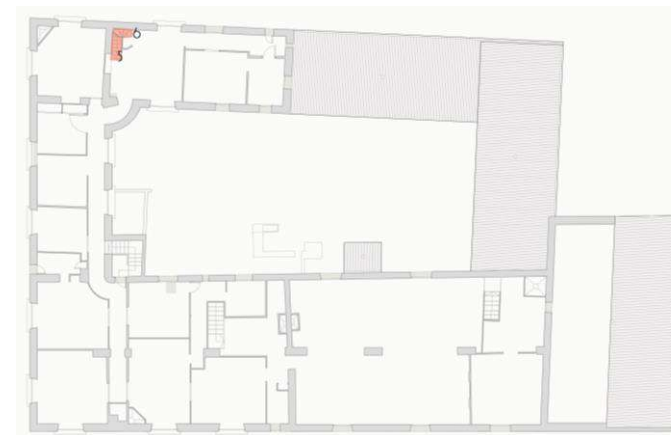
Plano de localización de las escaleras (P1). Fuente: propia
